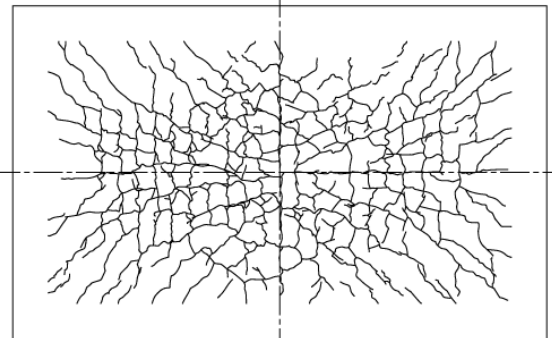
供試体 NS1 の補強前のひび割れ図
